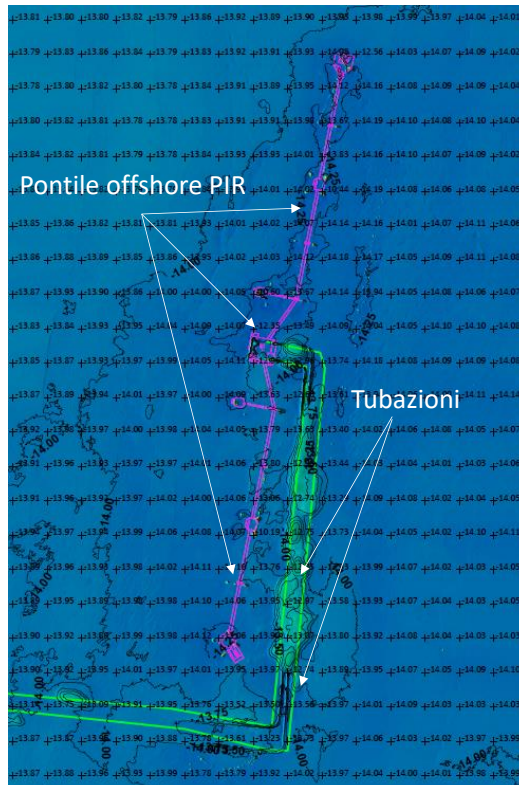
Planimetria del Pontile Offshore Petra (Pontile PIR) esistente.
